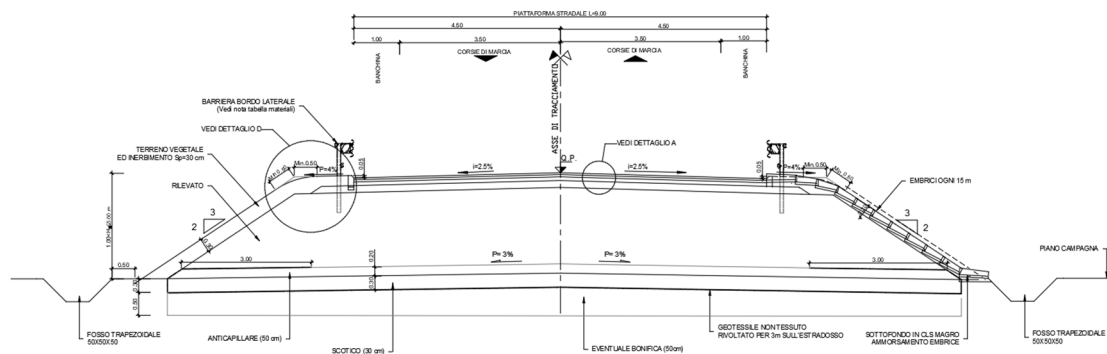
Sezione tipo di progetto in rilevato – F1-E
